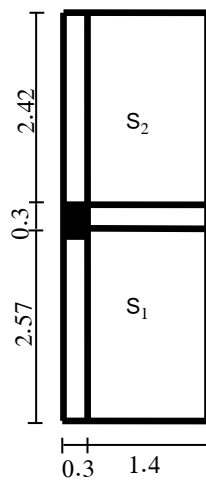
surface du plancher sur le poteau (poteau B-1)
